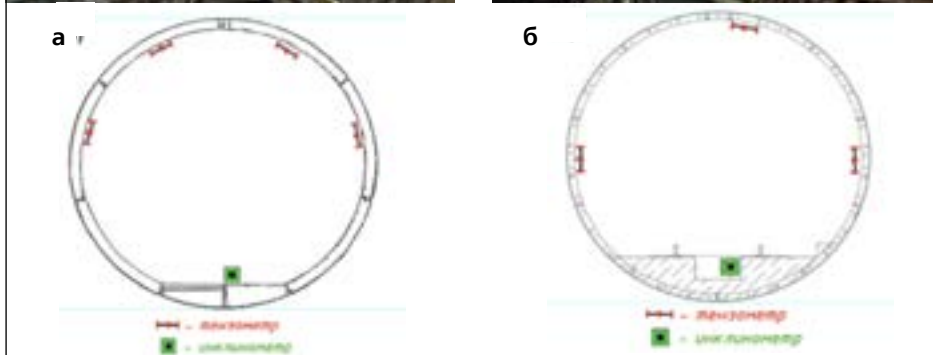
Схема расположения контрольно-измерительного оборудования в железобетонной обделке левого перегонного тоннеля метро (а); схема расположения контрольно-измерительного оборудования в чугунной обделке правого перегонного тоннеля метро (б)
